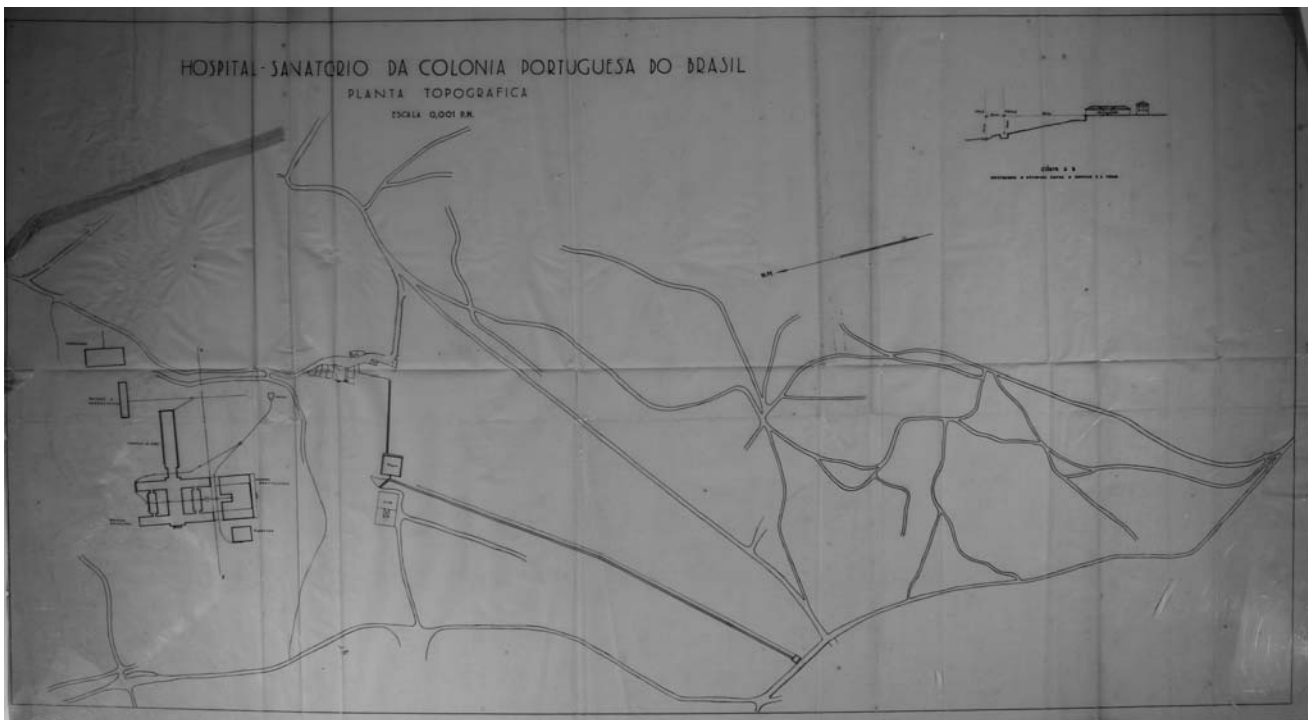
Planta topográfica. SIPA: DES\_815937.
